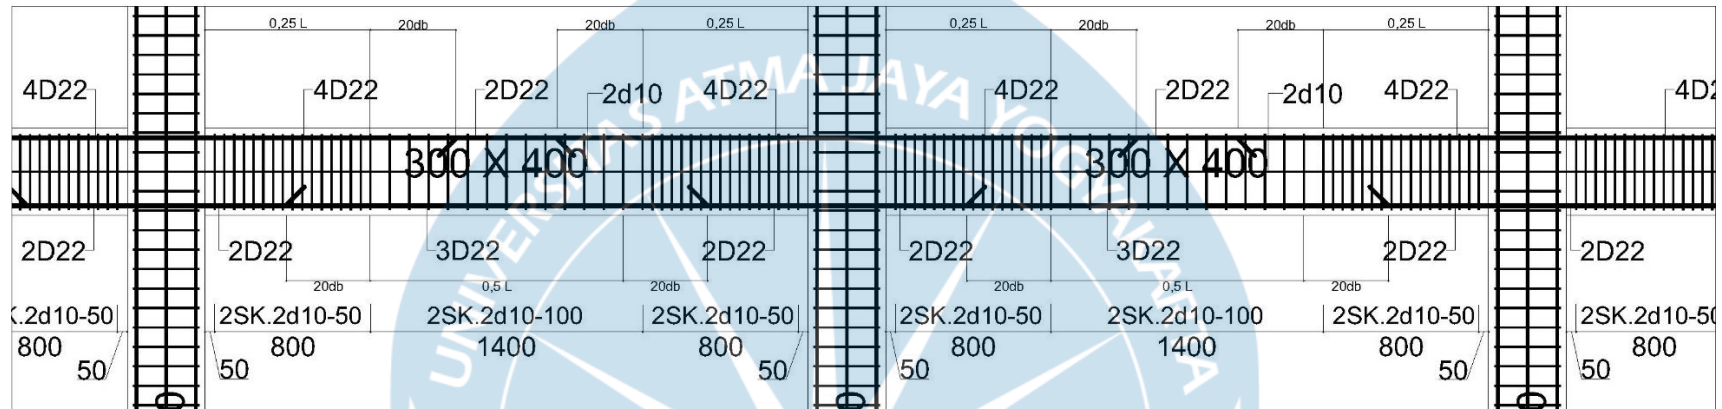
Detail penulangan balok lantai dag as B-C
